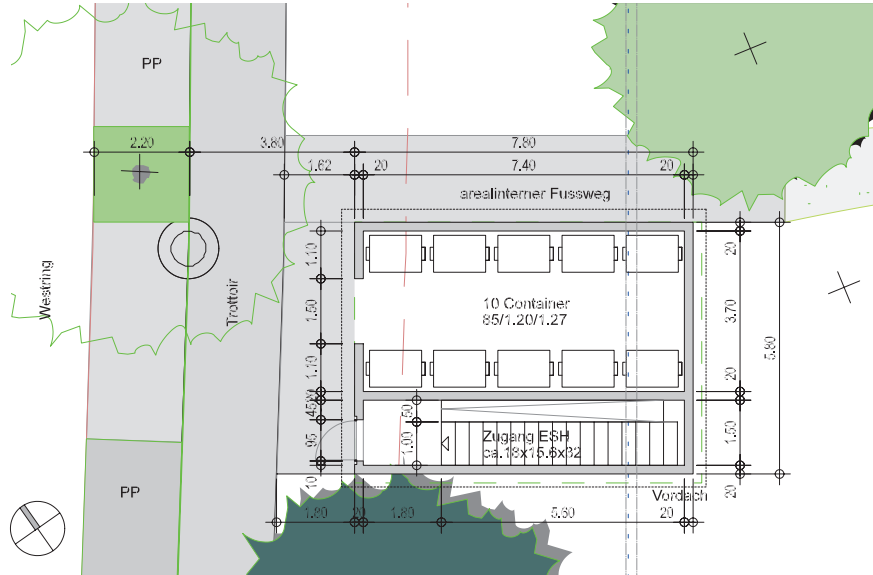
Oberirdische Erschliessung der Einstellhalle und Containerstellplätze
